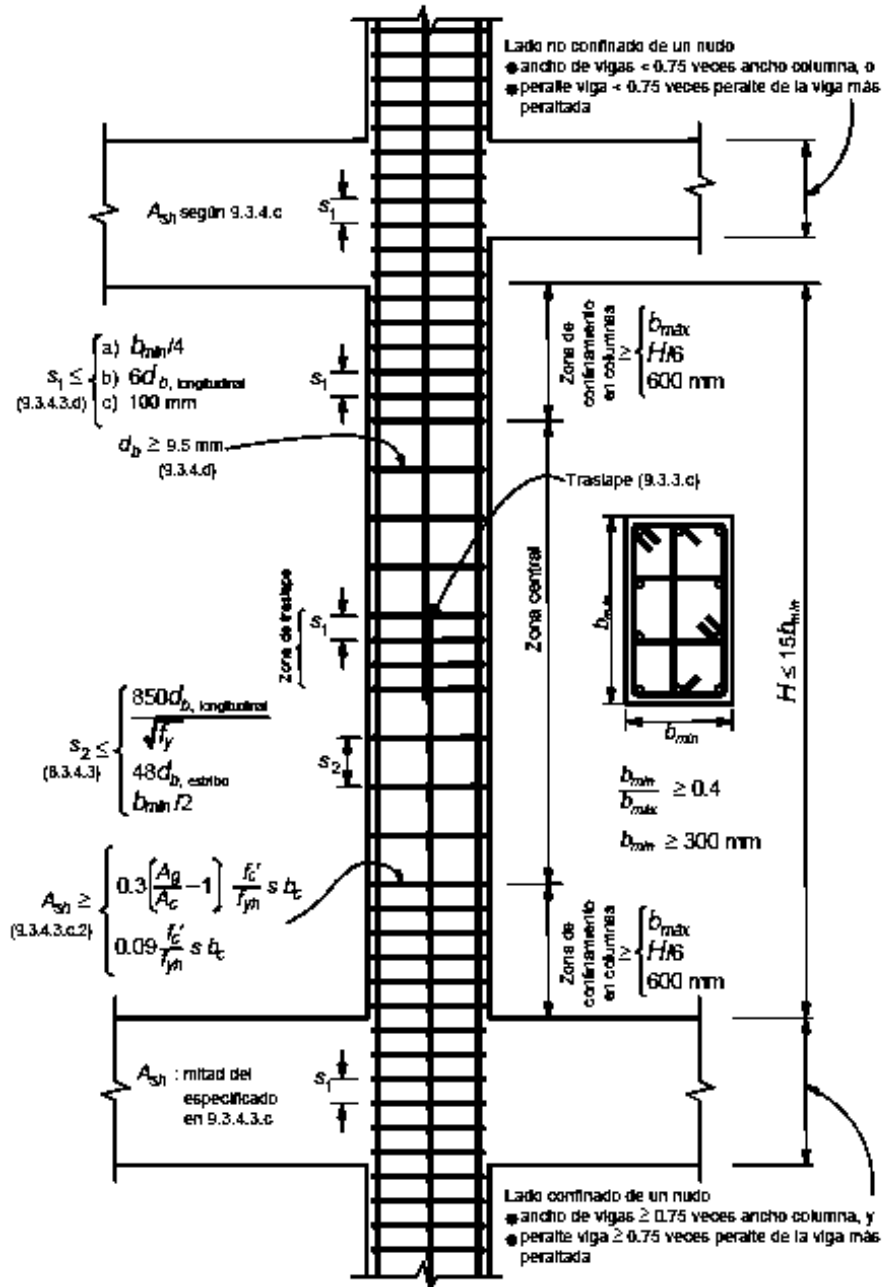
Detallado del refuerzo en columnas a flexocompresión (NTC-2017-CDMX).
